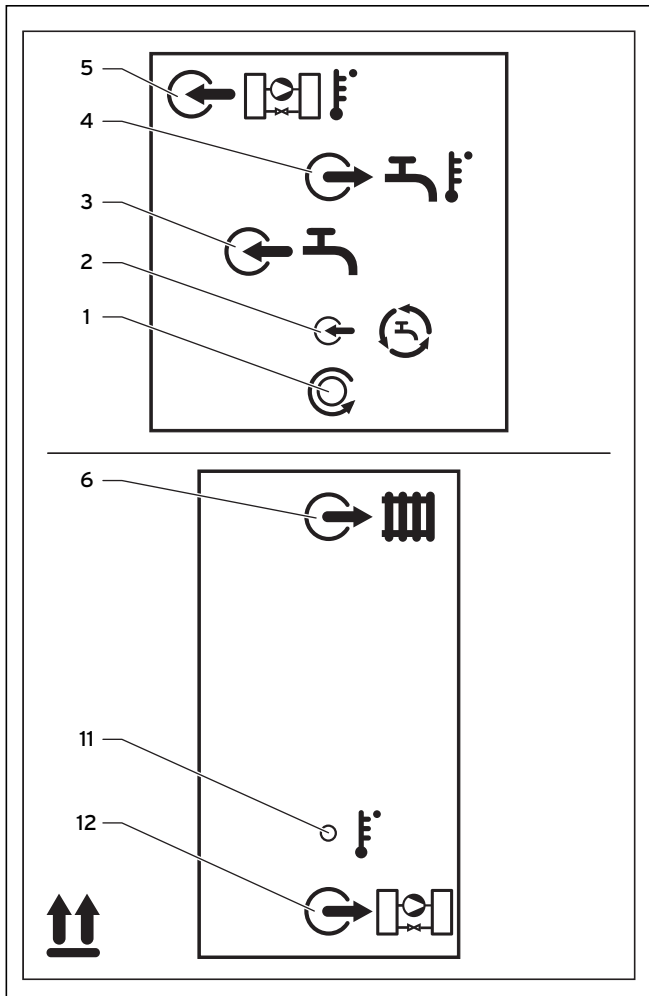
Aufkleber mit Schema der Anschlussverrohrung
